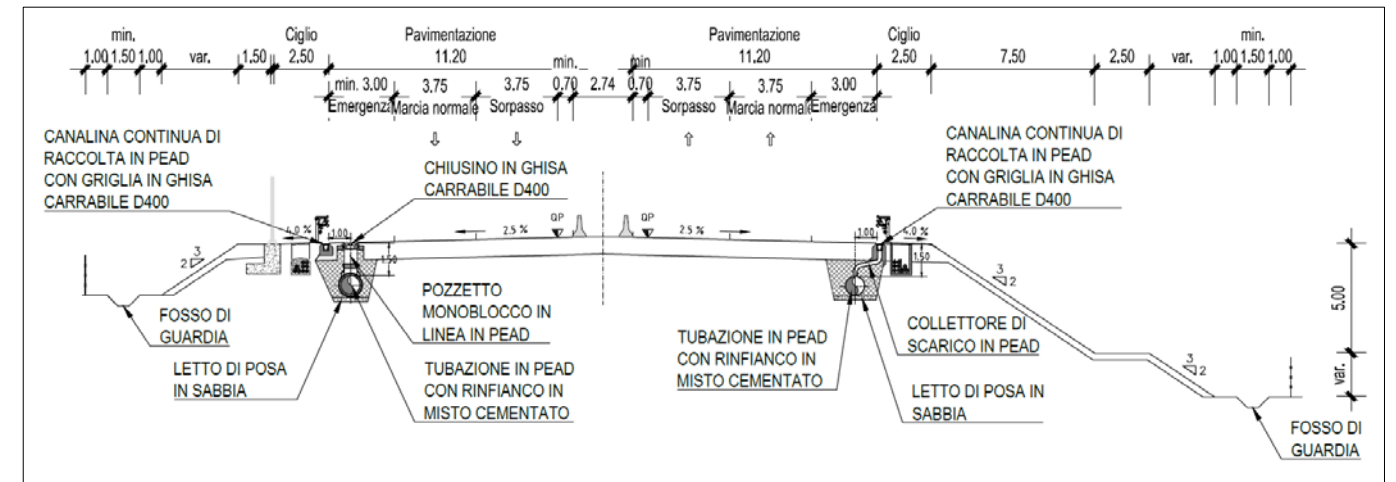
Schema di raccolta e collettamento delle acque di piattaforma nei tratti in rilevato (sezione tipo).
